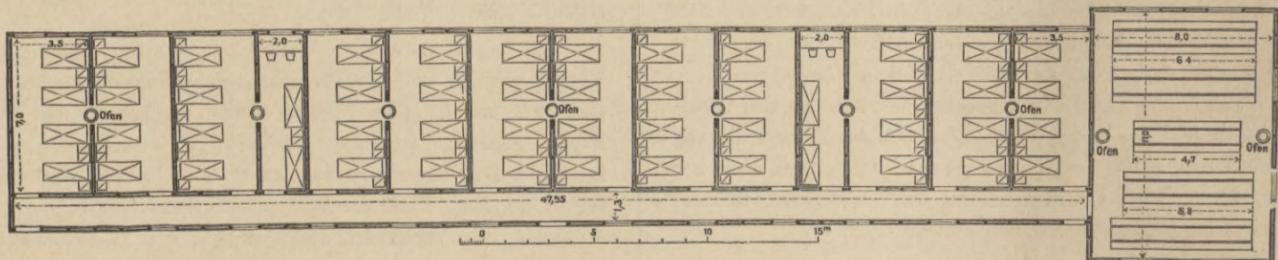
Grundriss einer Schlafbaracke für 100 Mann.
